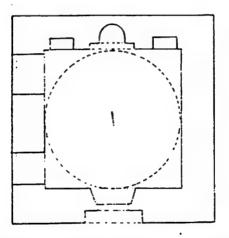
مسقط أفقى لمدرسة وقبة تغرى بردي عن كلر
